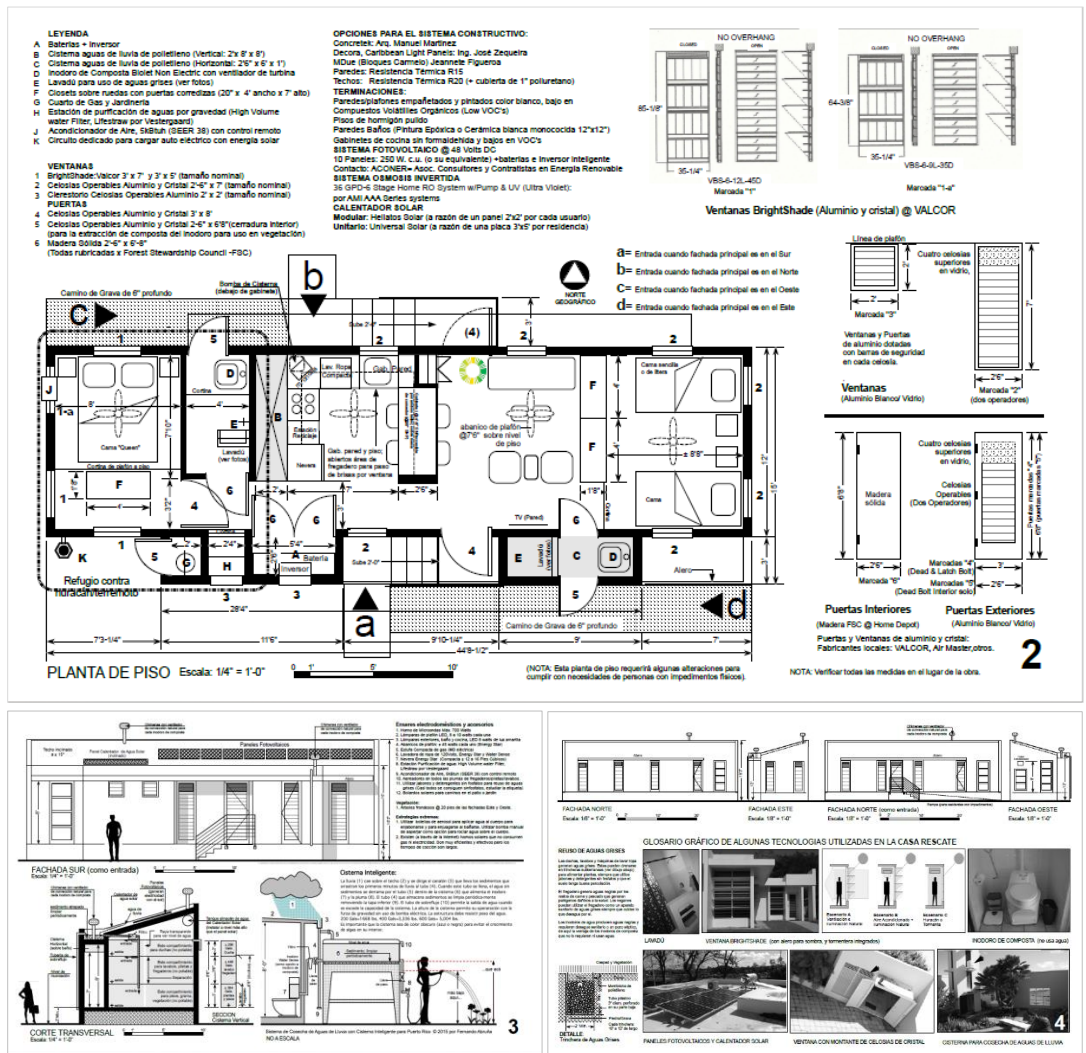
Plano de la Casa RESCATE (Fuente: Revista Diseño y Construcción, El Nuevo Día, 2017)
